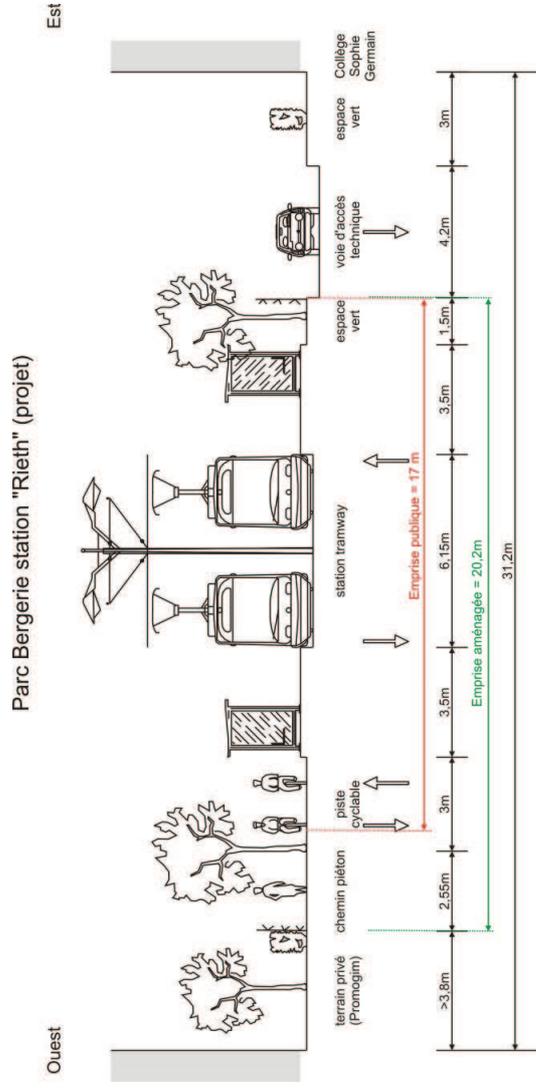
Situation projetée (coupe 9) sur le parc de la Bergerie (station Rieth)
